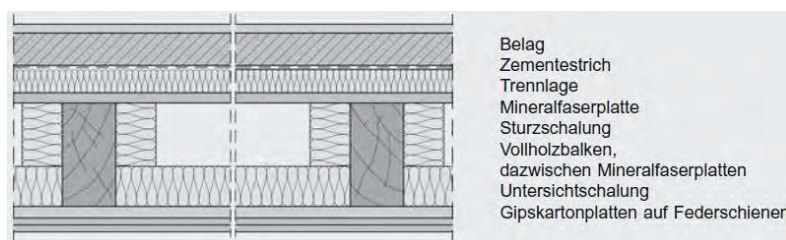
Aufbau einer Holzbalkendecke, [32]
